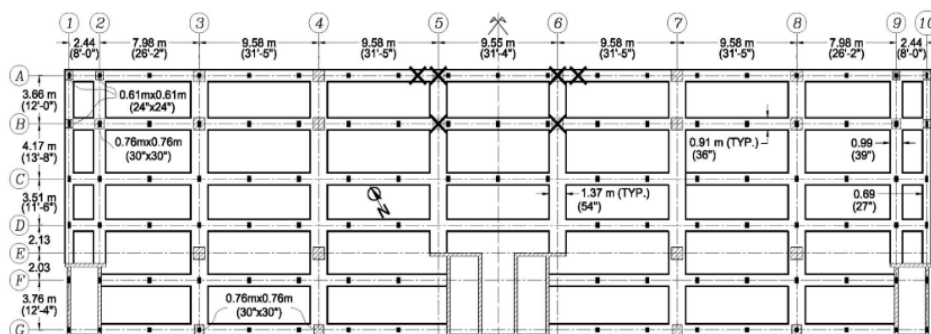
Planta estrutural do segundo piso (Sasani et al., 2011)
